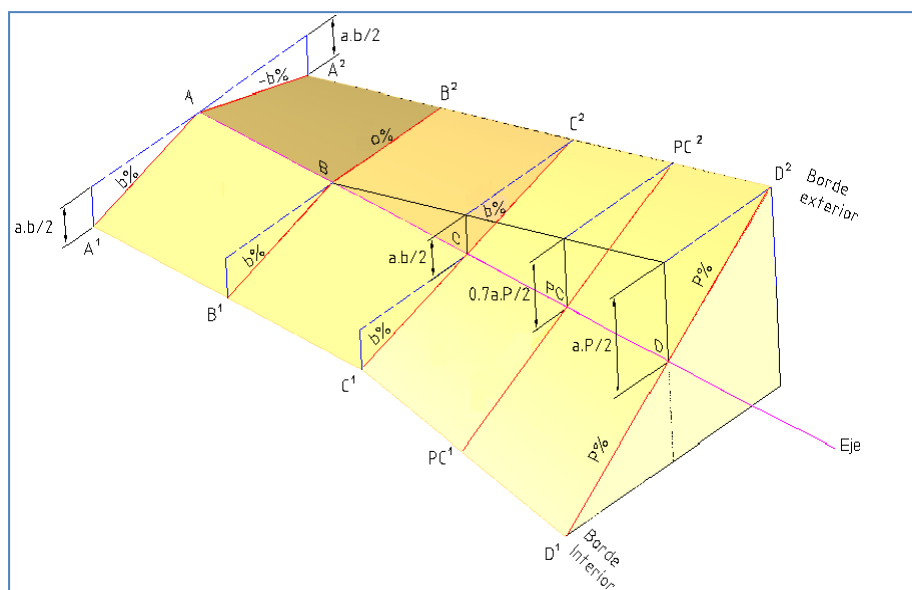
Vista tridimensional de la transición de peralte - Fuente: Civil Consulting & CAD Express
